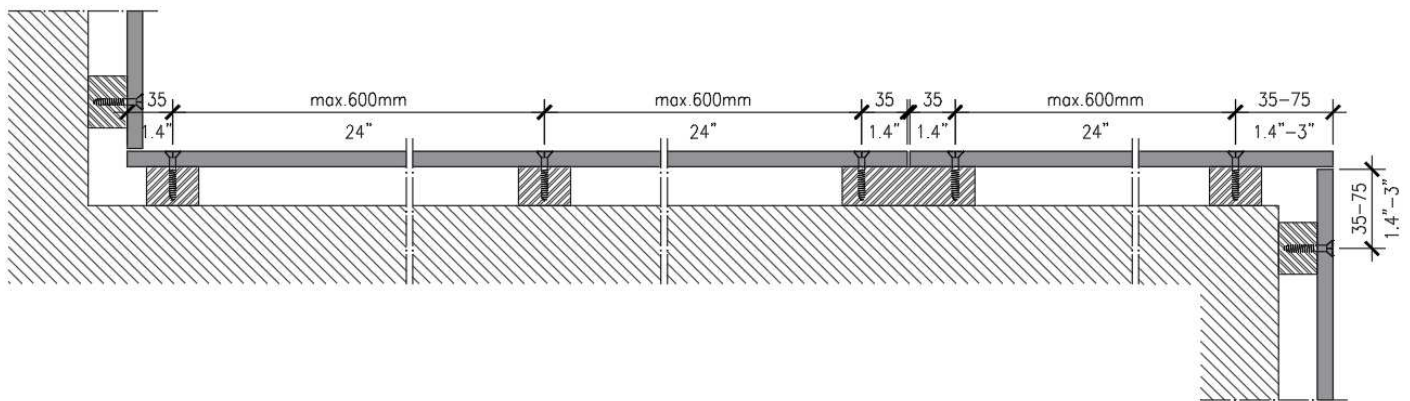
Section horizontale de revêtement mural, ossature bois
